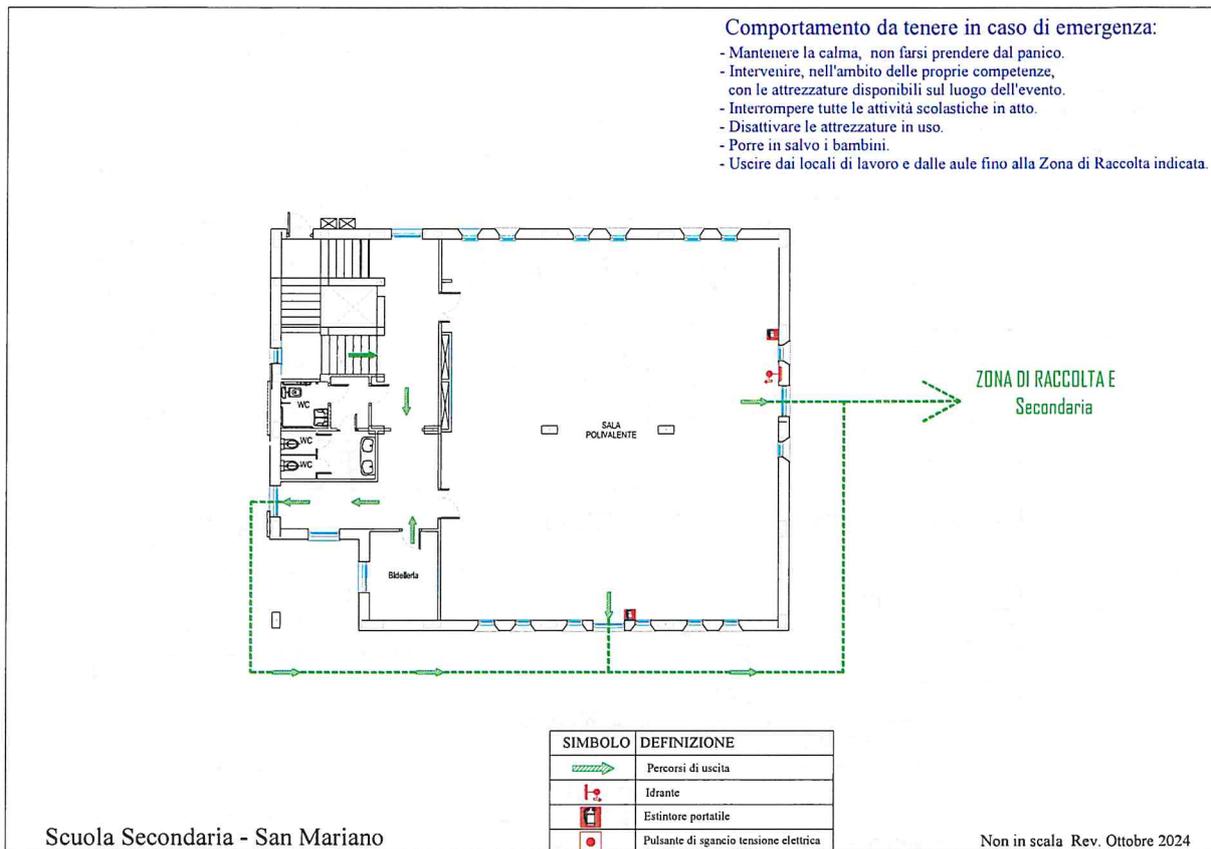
Pianta Emergenza Piano Scuola Secondaria San Mariano – Ampliamento Piano inferiore
